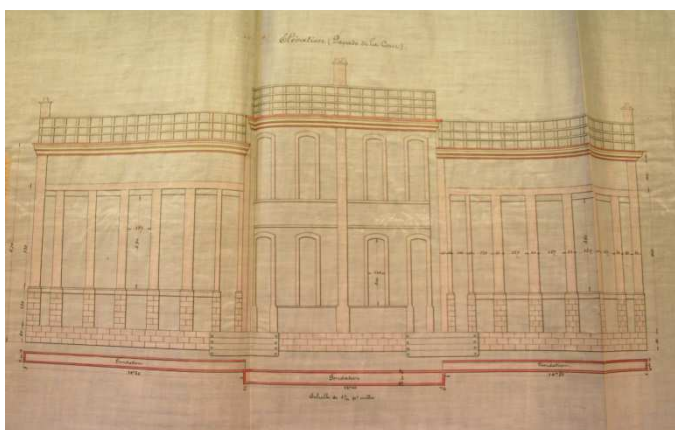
Projet de construction d'un groupe scolaire laïque, plan des lieux.
